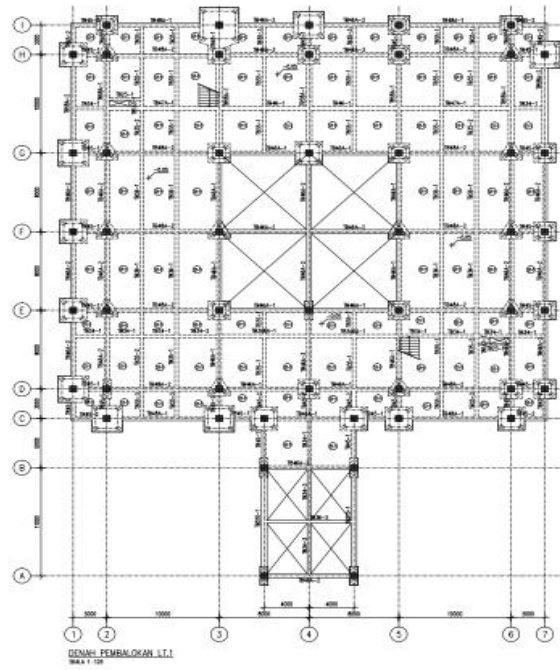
Denah Lokasi Kolom Lantai 1
